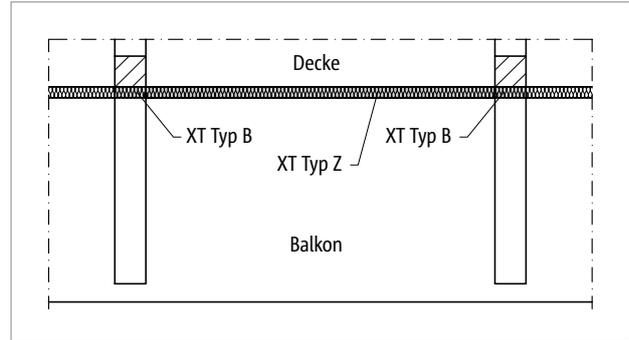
Schöck Isokorb® XT Typ B: Balkonkonstruktion mit frei auskragenden Unterzügen
